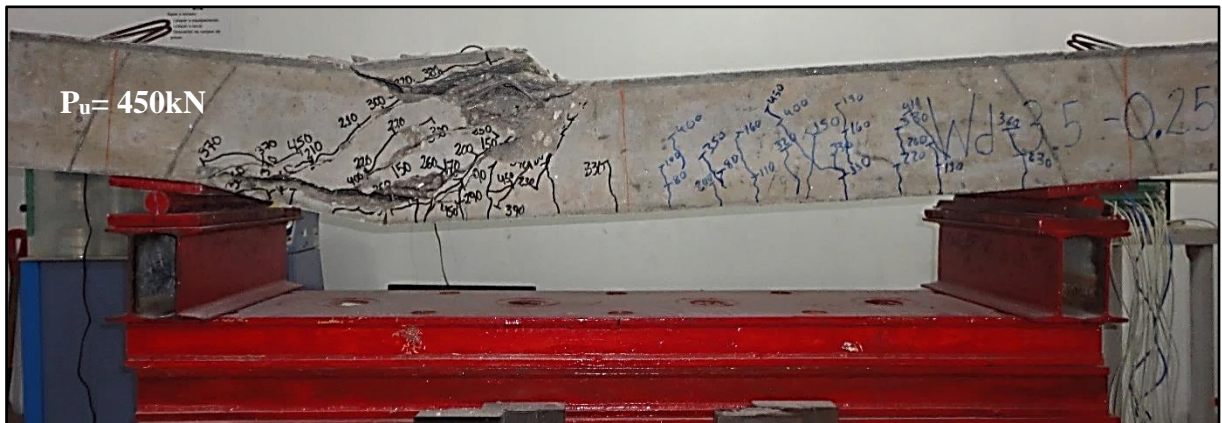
Mapa de fissuração da viga S-3.5-0.24
